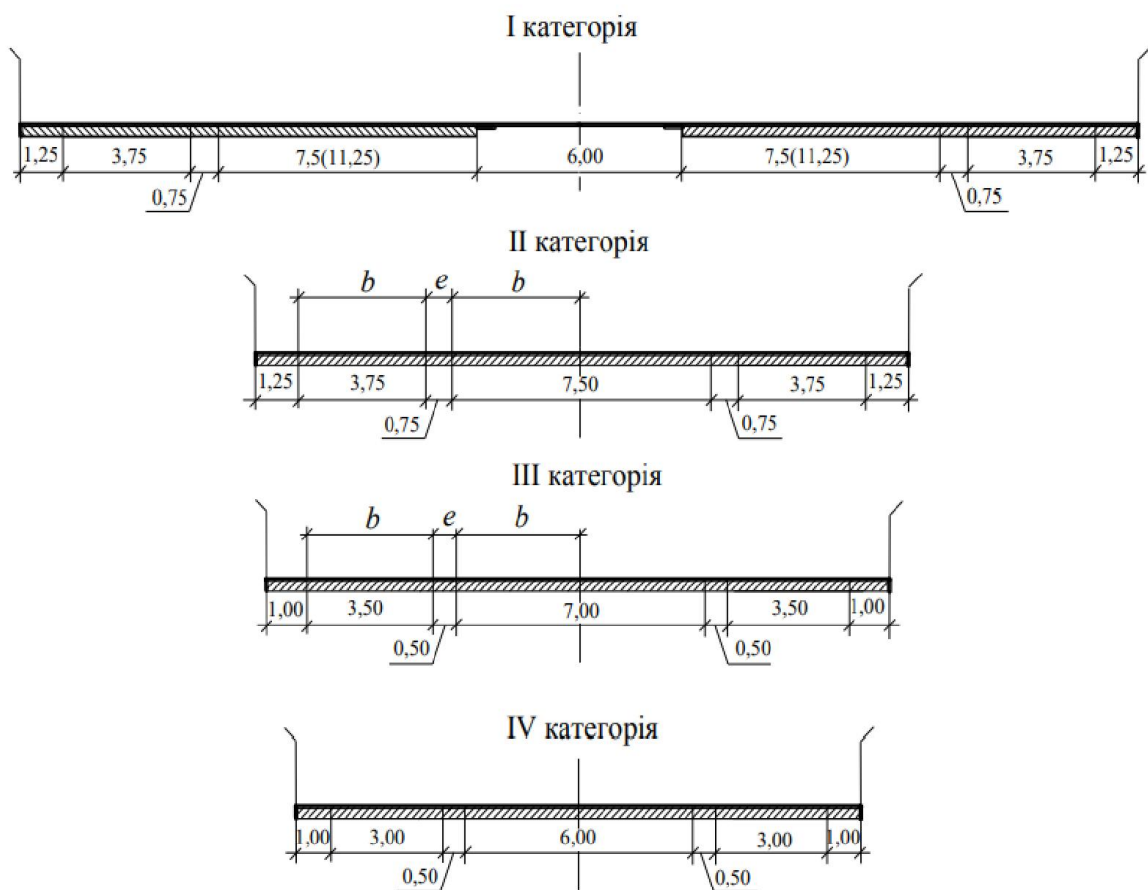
Схеми поперечних перерізів шляхопроводів на розв'язках доріг
